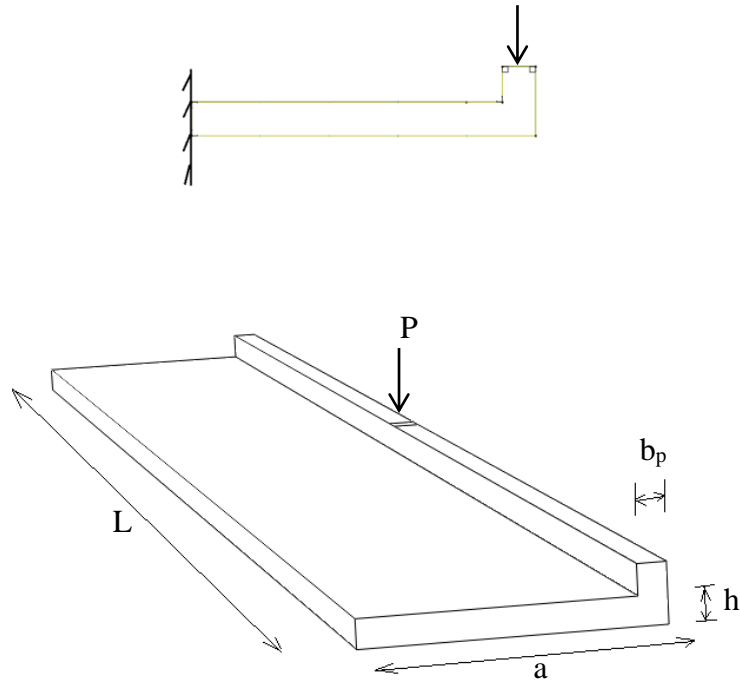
Plancher en porte-à-faux avec raidissement au bord libre
